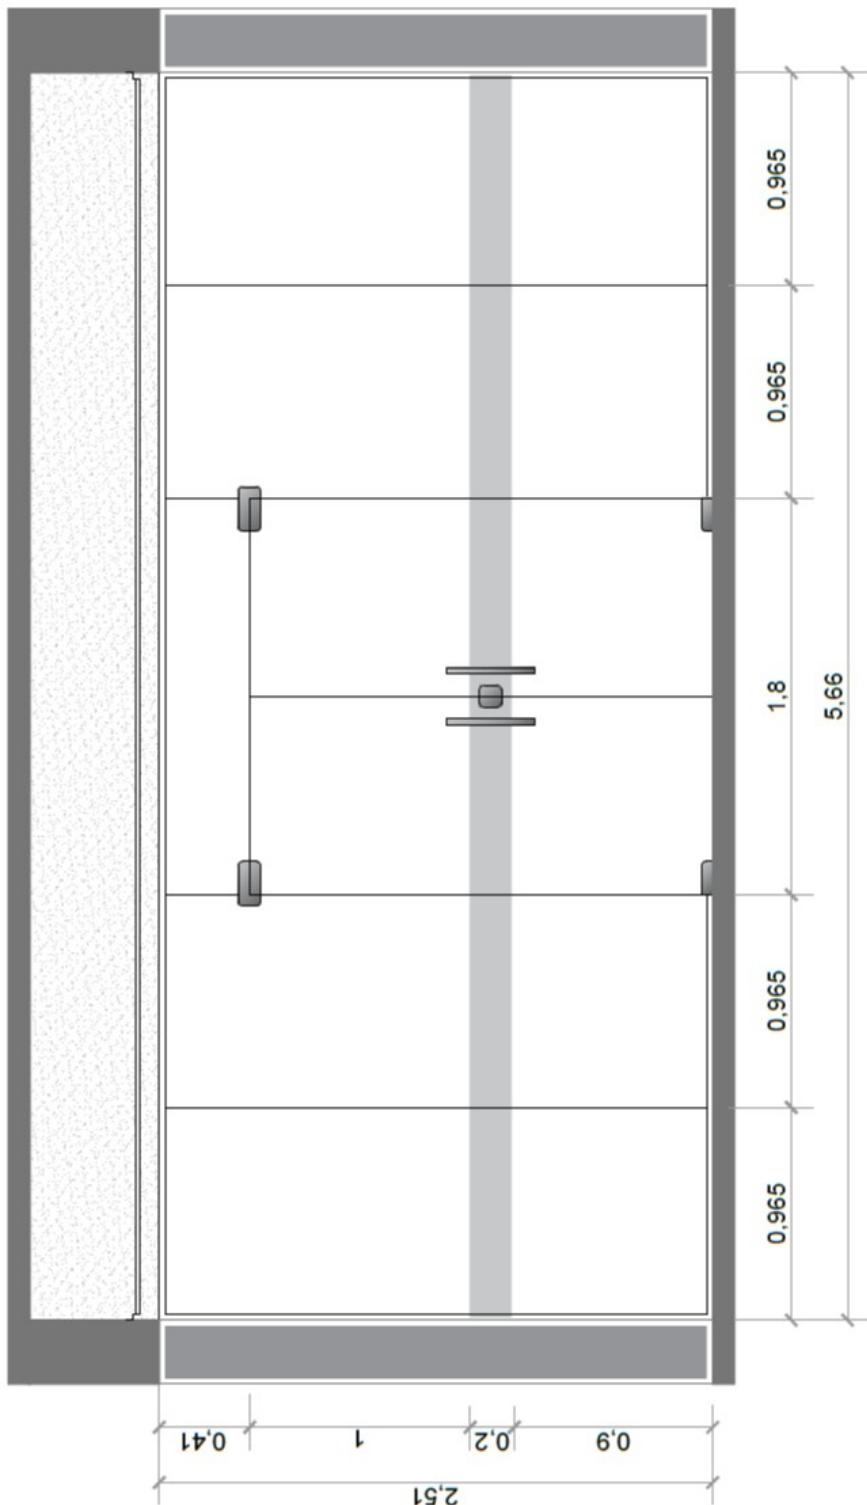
Elevação da divisória de vidro vista a partir do hall dos elevadores.
